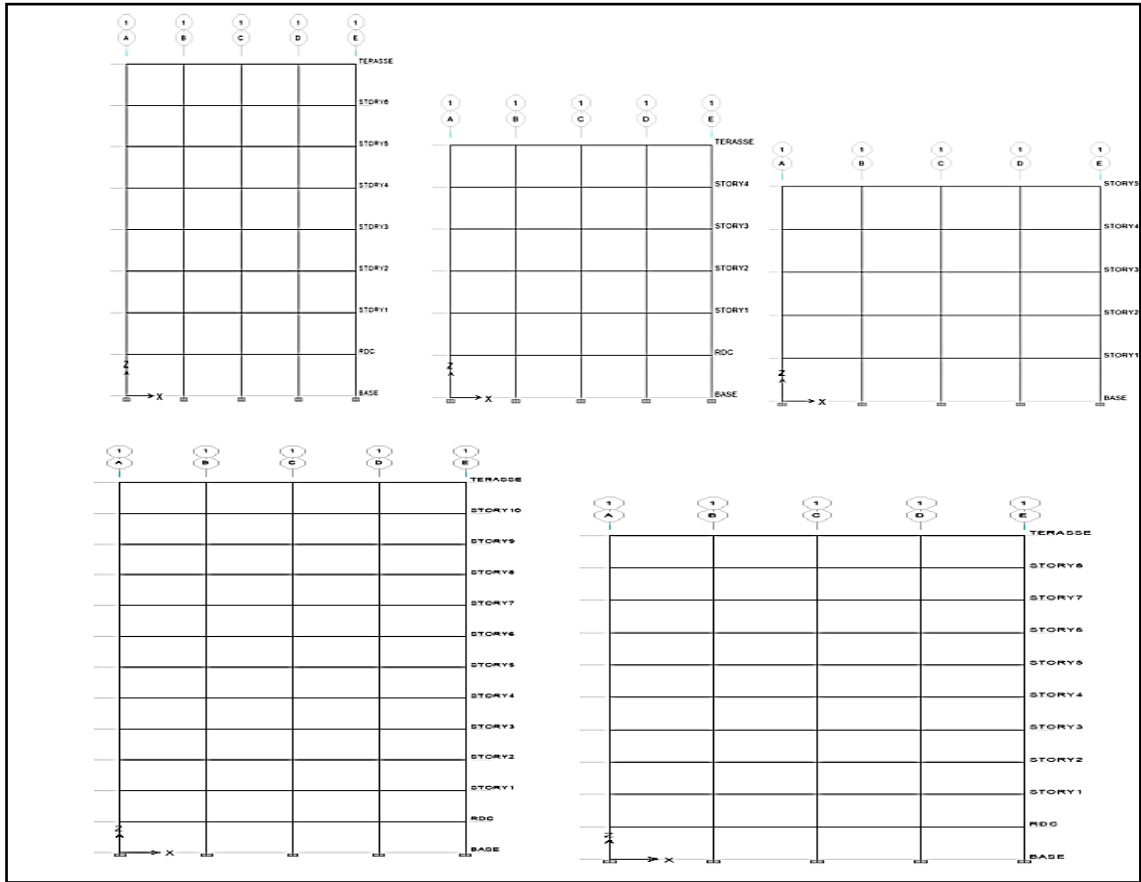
Vue en elevation des bâtiments R+4 , R+5, R+7, R+9, R+11.
